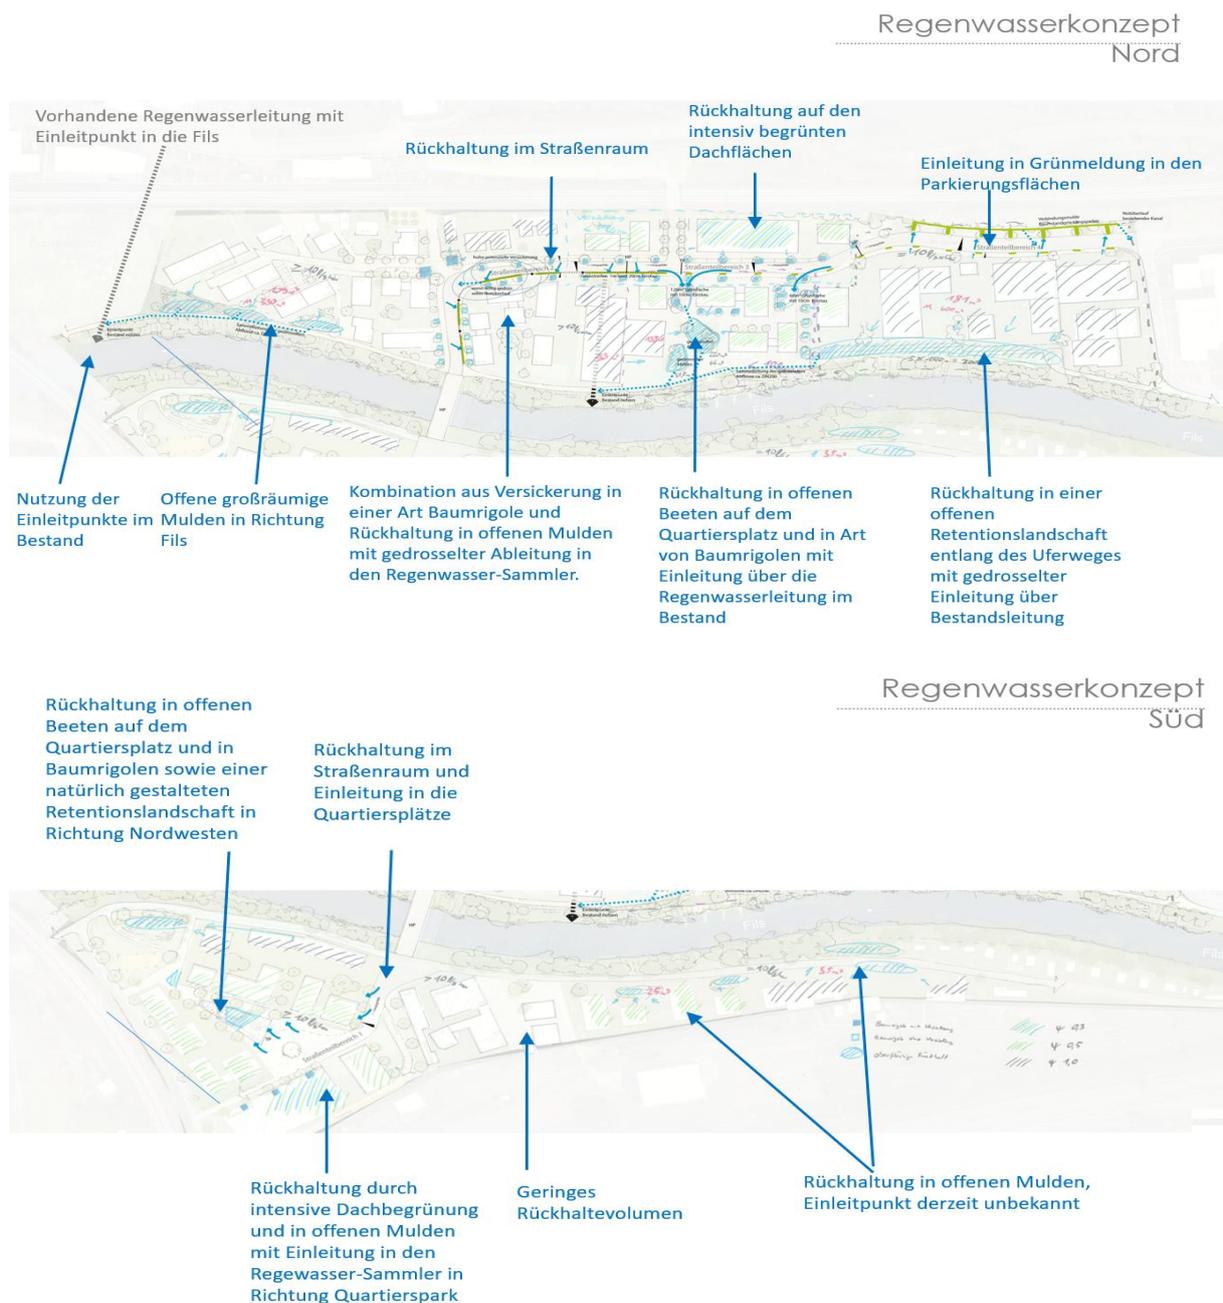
Übersichtlageplan einzelner Maßnahmen Planstatt Senner GmbH
